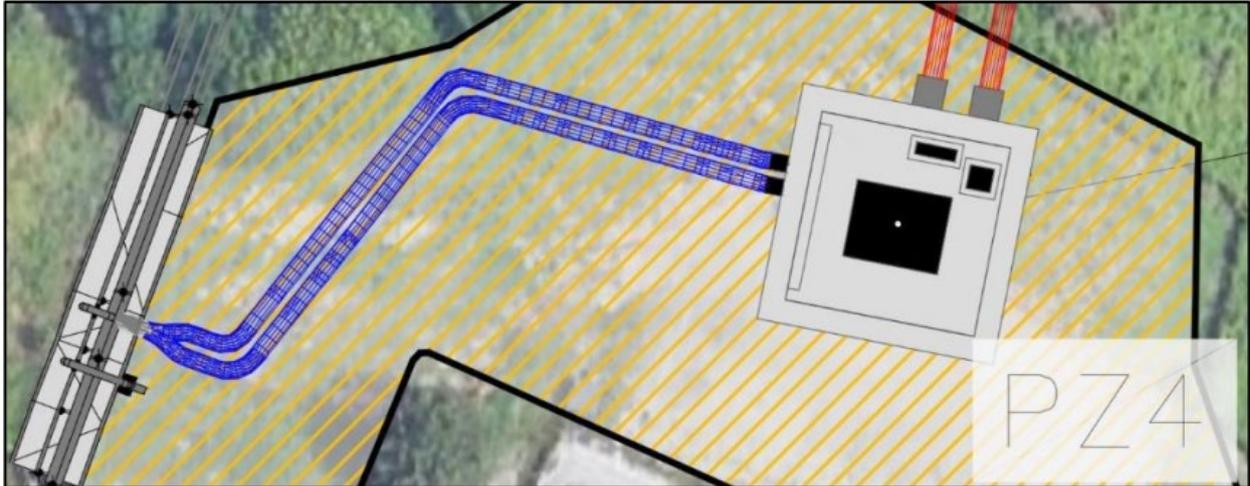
Tratto T5 di collegamento tra il pozzo PZ4 e la condotta esistente (in blu)
